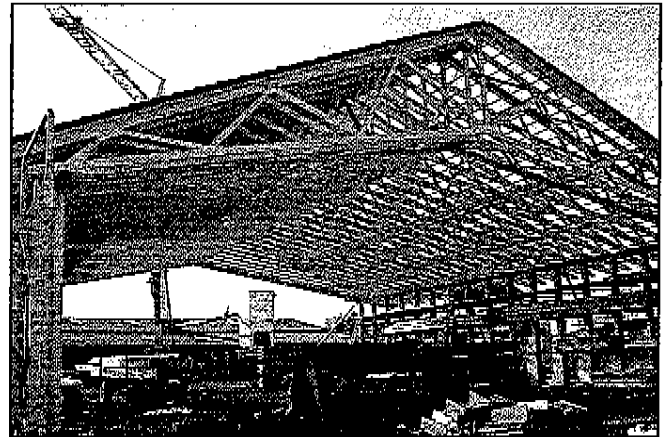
Dachkonstruktion mit Nagelplattenbindern.
